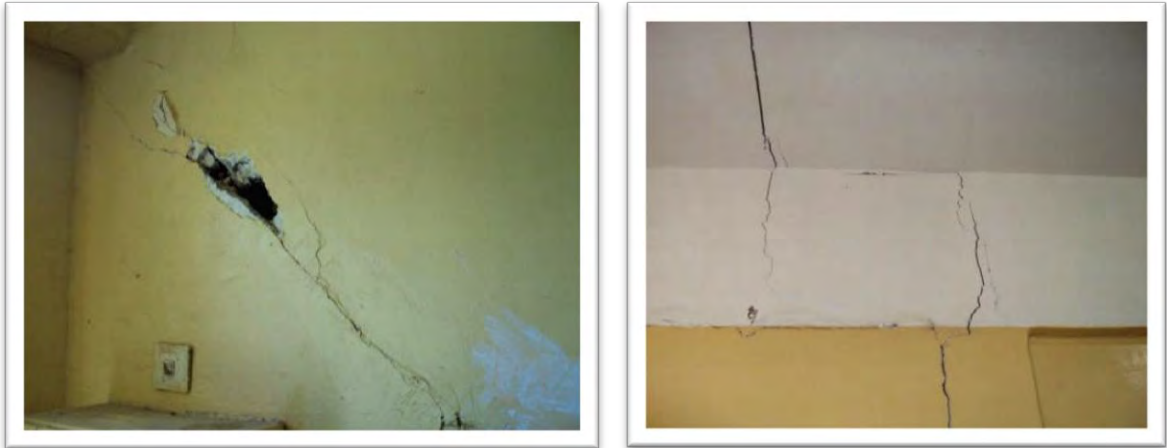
Fissure aux niveaux des murs et cloisons.
